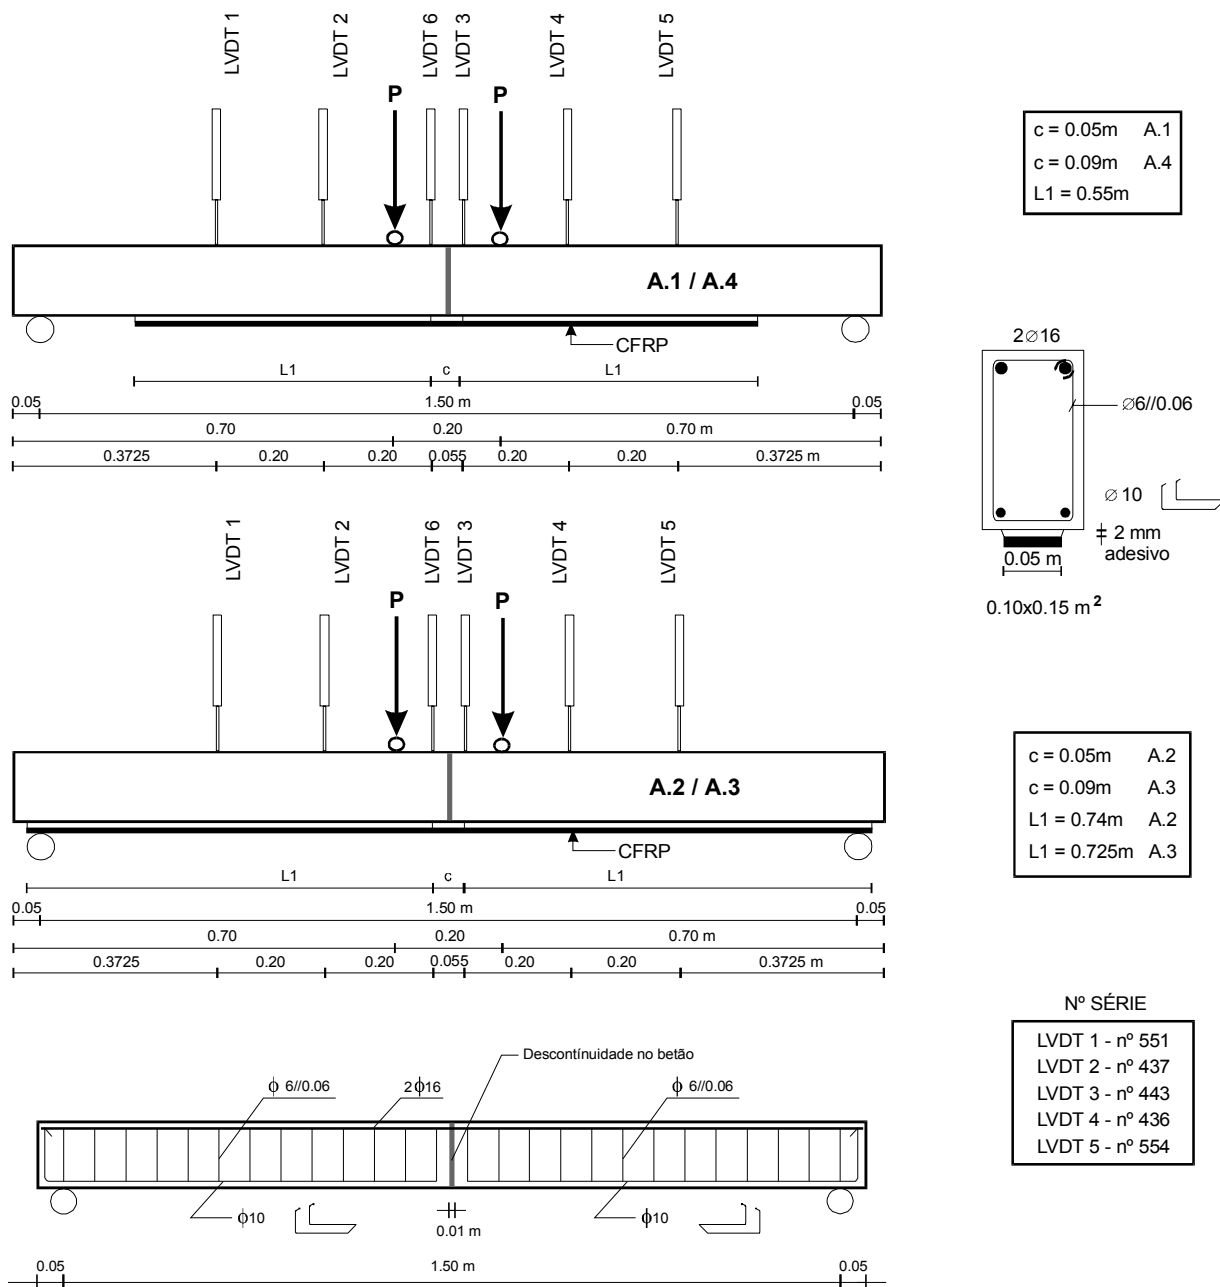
Geometria, armadura, carregamento e instrumentação utilizados nas vigas *tipo A*.
